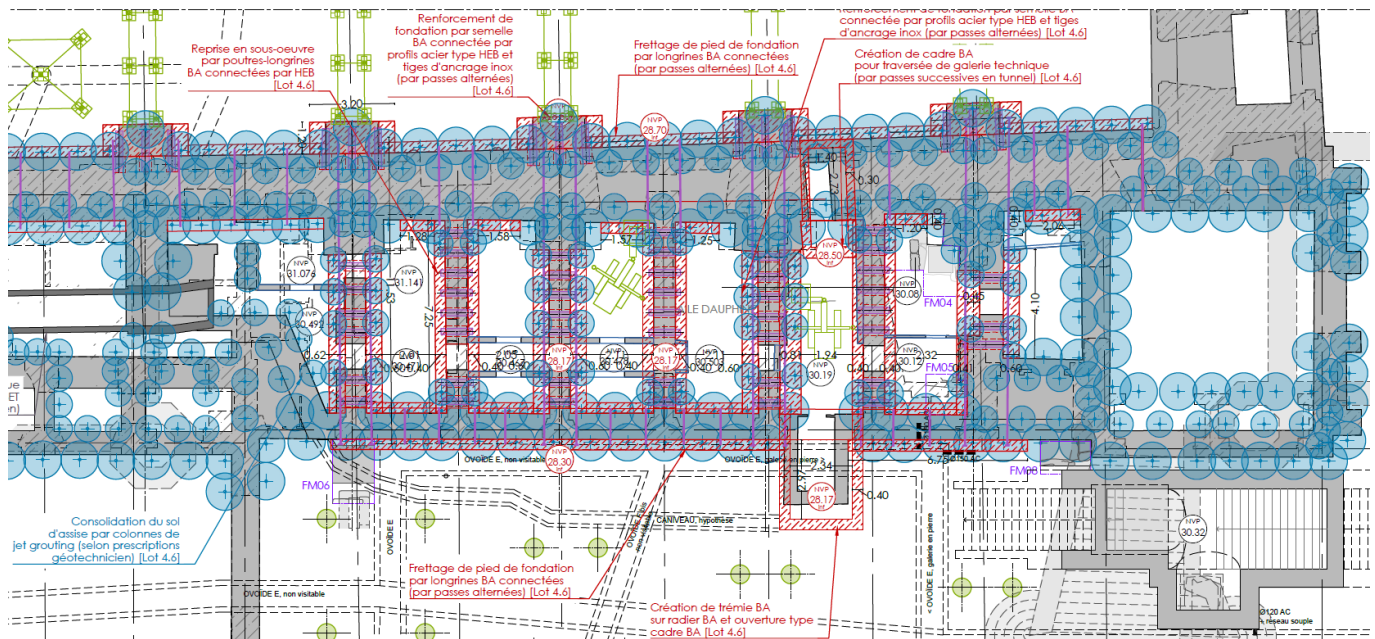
Plan de principe de l'implantation des colonnes de jet grouting au droit de la façade Nord (Galerie Dauphine)
